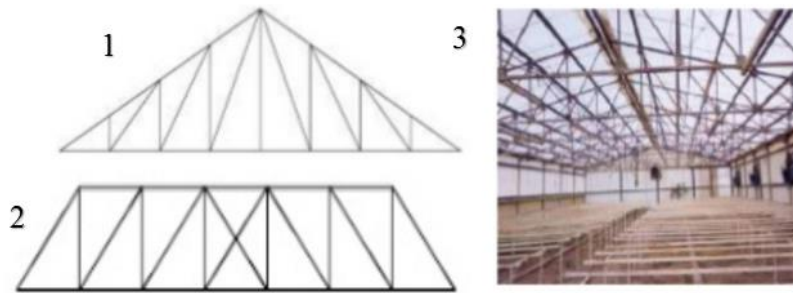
Armaduras Pratt 1.) Armadura tipo Pratt 2.) Armadura tipo Pratt (cuerdas paralelas)3.) Armadura tipo Pratt (invernadero).(Bellido et al., 2015)
